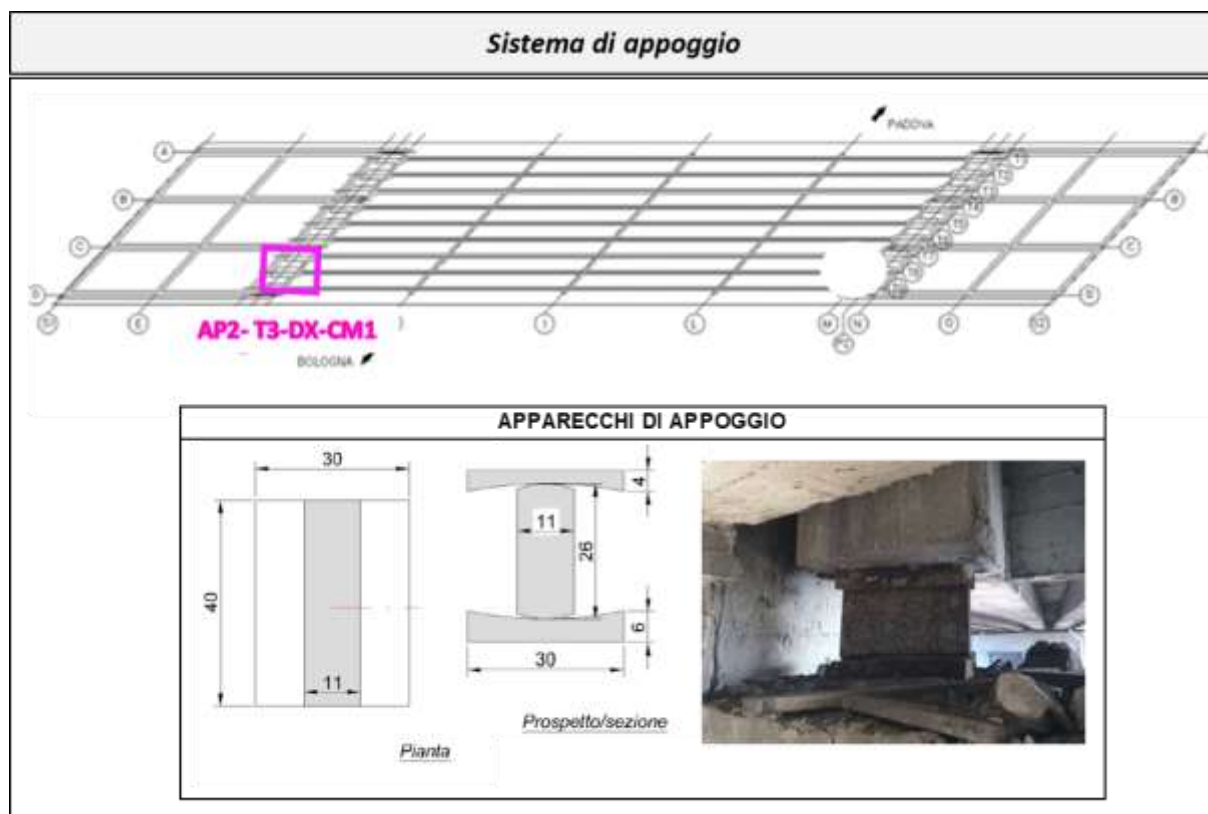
Esempio di restituzione- Apparecchi di appoggio
